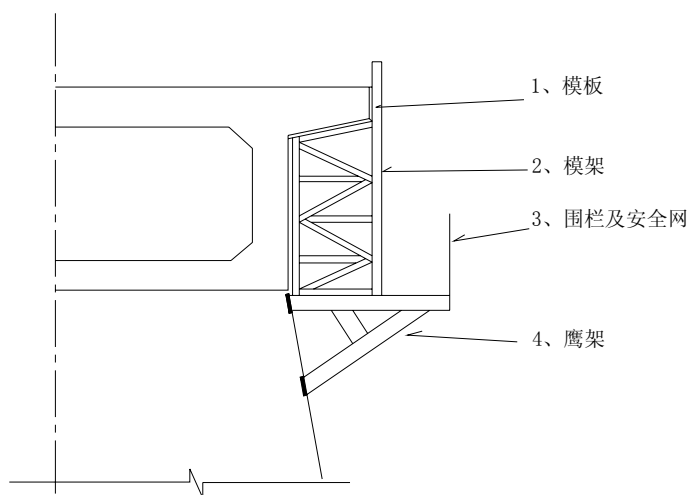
0 号梁段施工侧面膺架示意图
